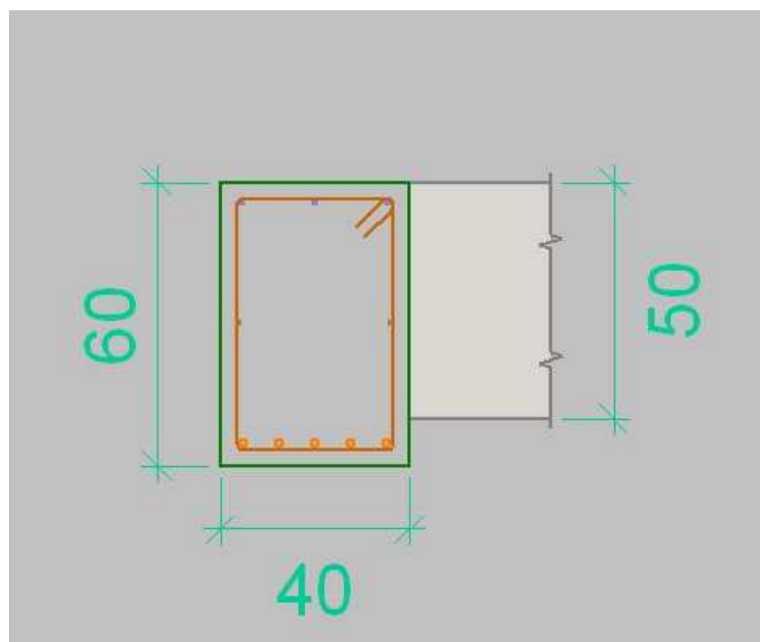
Secció de la biga ubicada entre els pilars P4 i P5 al Sostre de la Planta una vegada modificat l'armat.
